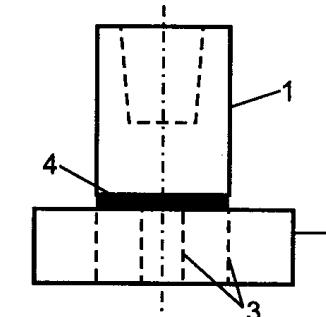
Неудачное решение сборного фундамента под колонну, выданное вместо монолитного варианта:
